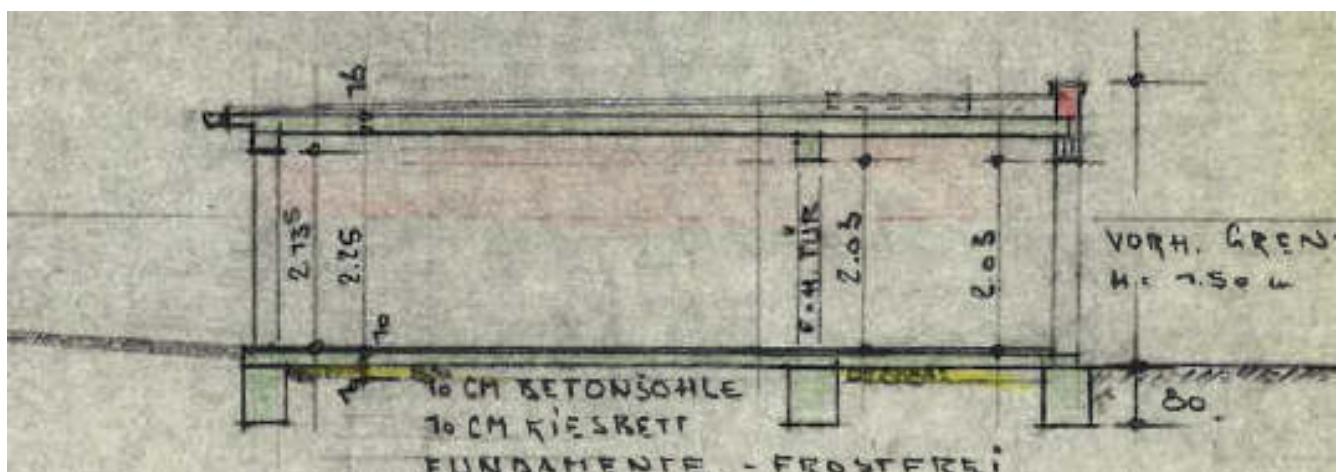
Schnitt Garage (ohne Maßstab) von 1975; Quelle: Bauakte der Stadt Hanau
